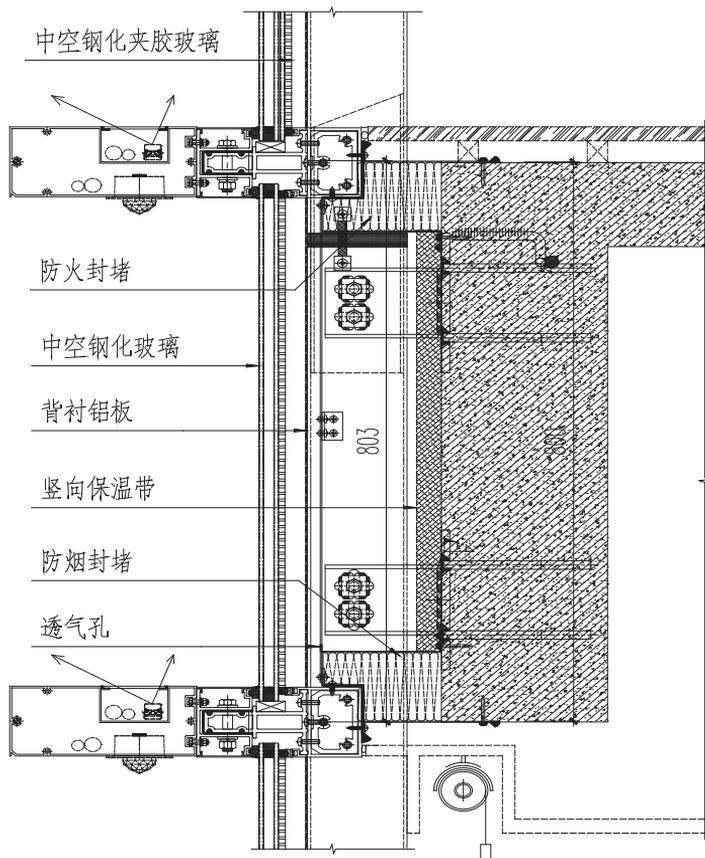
层间防火构造处理(2)-楼面边缘的钢筋混凝土梁板
